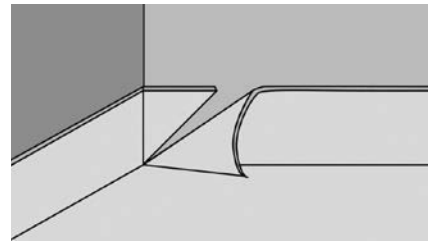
Прогрейте покрытие и, используя угловой ролик, прижмите покрытие в соединении между полом и стеной. В помещениях, где достаточно одного куса напольного покрытия, клей может быть нанесен на всю поверхность основания, куда будет укладываться покрытие. Хотя это требует опыта, этот метод является самым быстрым.
